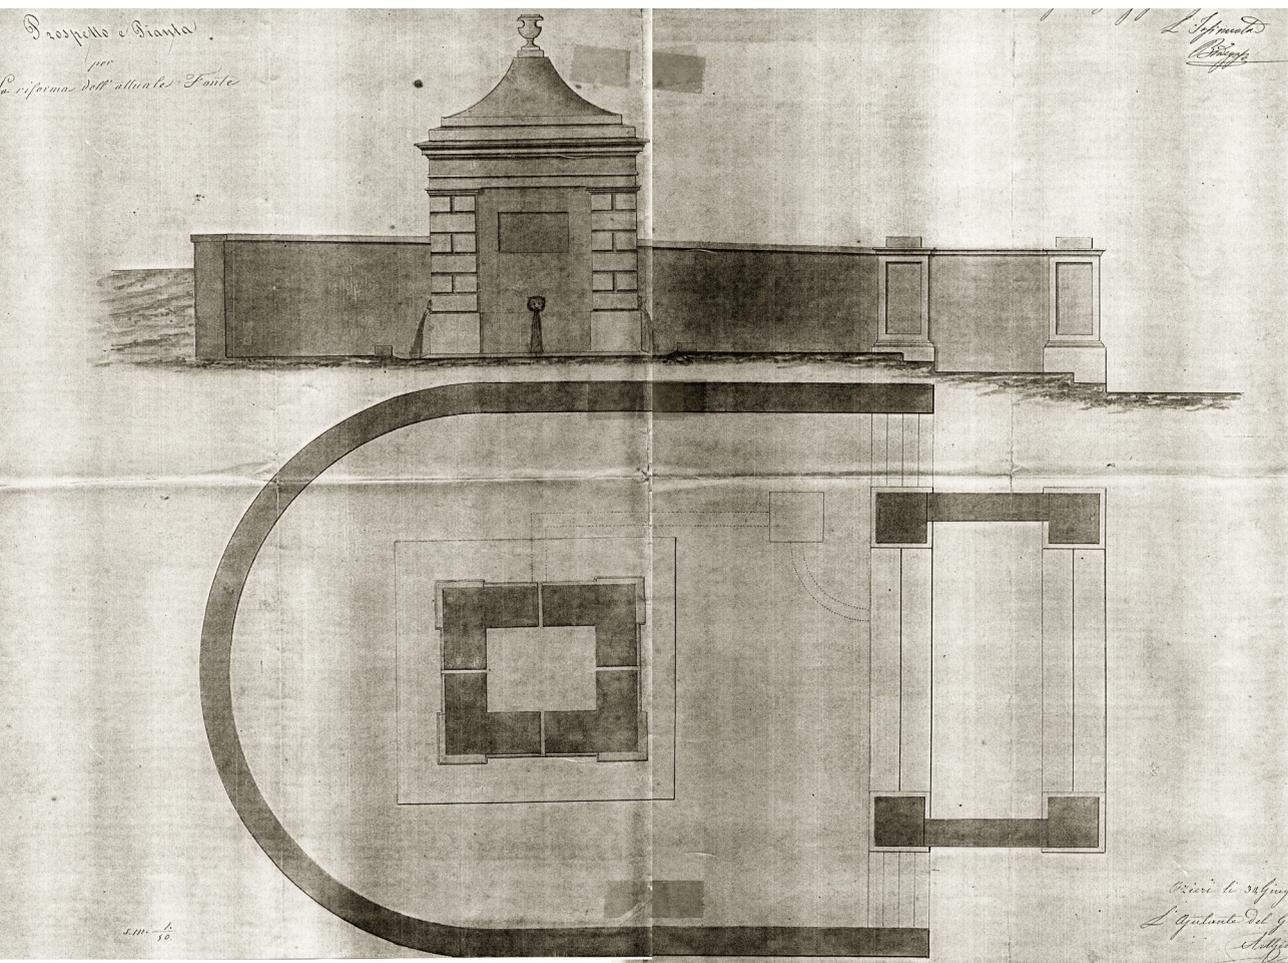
Prospetto e Pianta Per La Riforma dell'attuale Fonte, Arthemalle, 1854* (Archivio privato Dott. Cau). La soluzione planimetrica prevede il corpo isolato della fontana, su di una base rialzata, e prospiciente vasca (forse con funzione di abbeveratoio o forse di lavatoio). Il sistema è racchiuso da una muratura semicircolare che abbraccia la fontana su tre lati. Il disegno in pianta comprende anche la canalizzazione del flusso d'acqua dalla vasca della fontana a quella successiva. Il prospetto rappresentato è dotato di sede per lapide.
